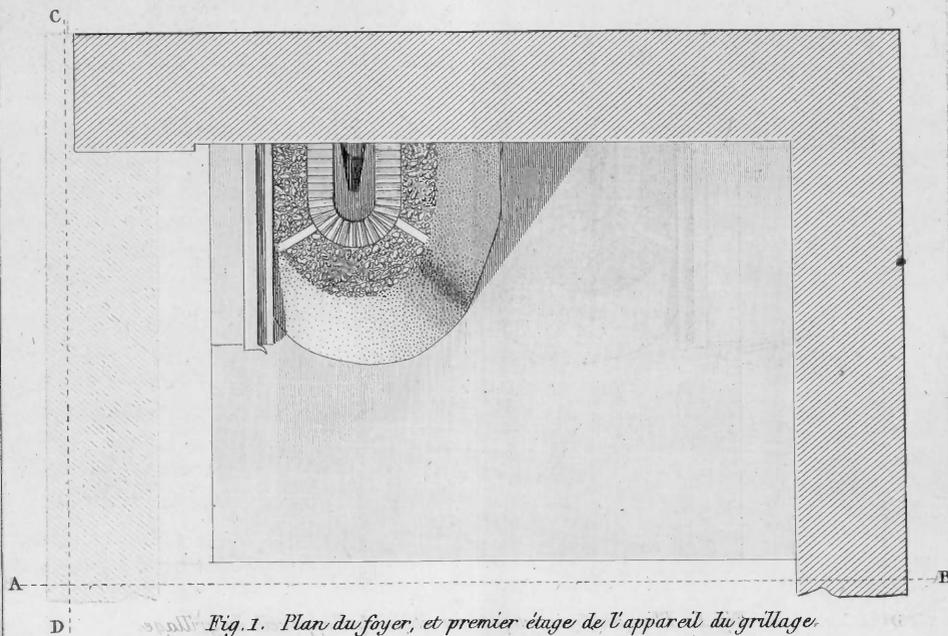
Plan du foyer, et premier étage de l'appareil du grillage.
